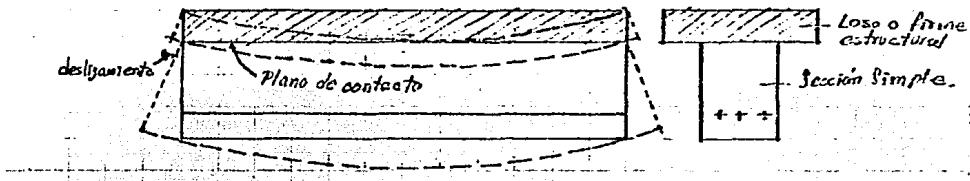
Deslizamiento en el plano de contacto de las dos etapas de una viga compuesta.
